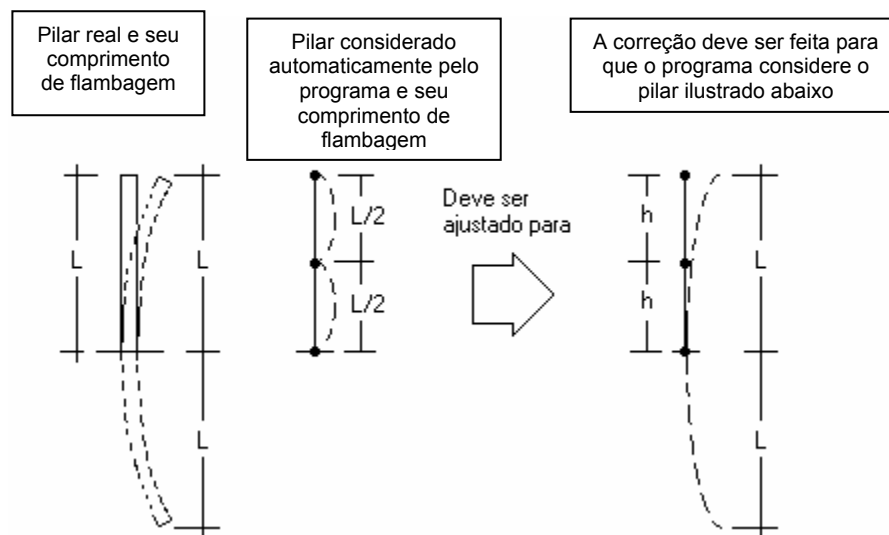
Comprimento de Flambagem no Plano da Cobertura.
